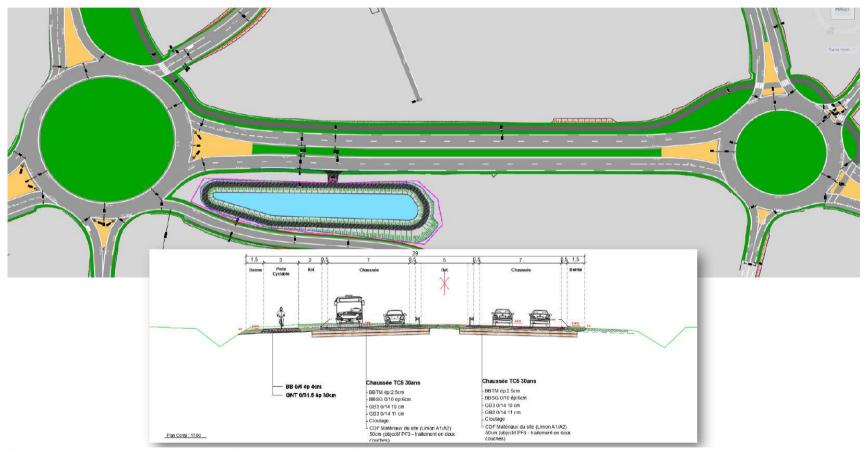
Plan de la RD650 centre de la solution retenue pour le projet
